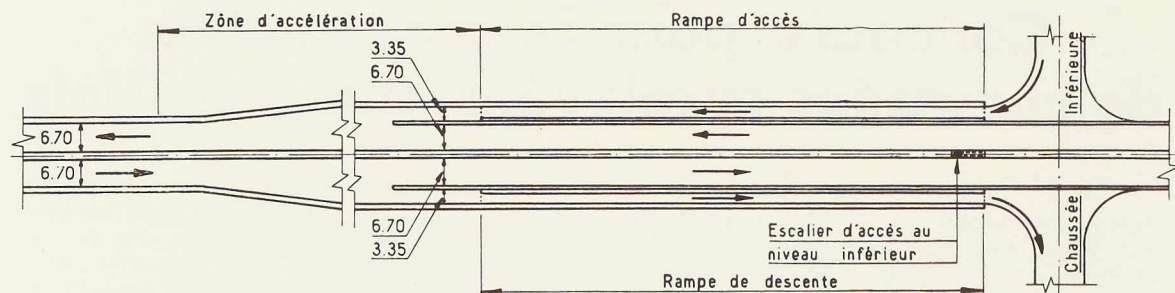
Vue du plan montrant un croisement à niveaux différents et la disposition des voies d'accès à la route surélevée.
